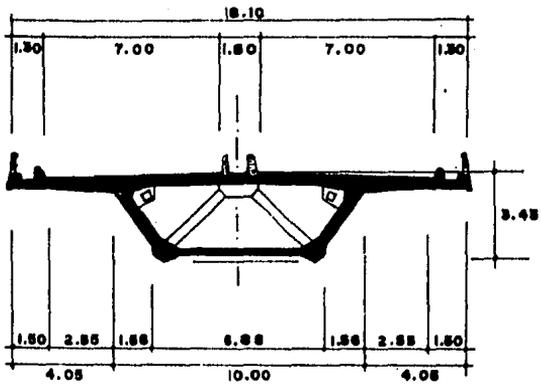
SECCION TRANSVERSAL DEL TABLERO
